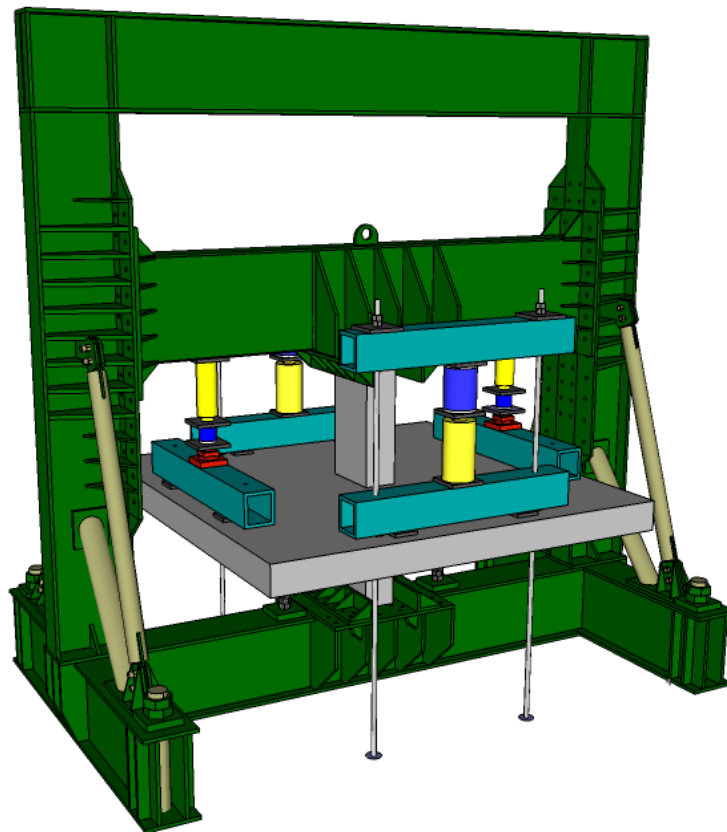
Esquema de ensaio do pórtico metálico.
